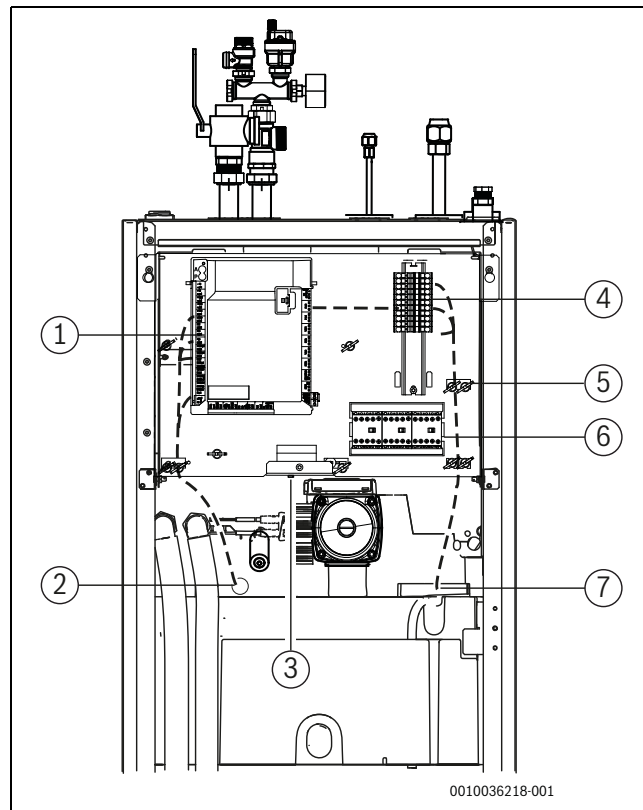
Vue d'ensemble des chemins de câbles et des composants électriques
